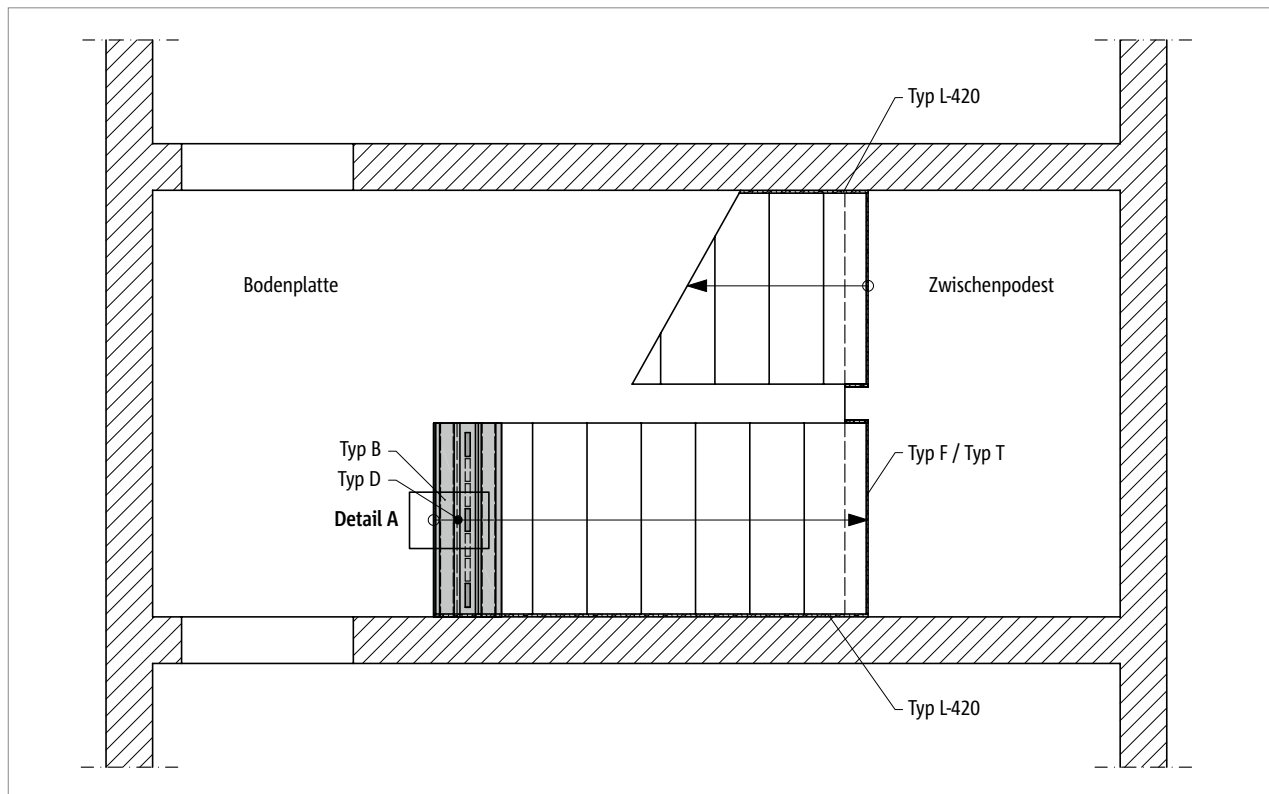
Schöck Tronsole® Typ B + Typ D: Elementanordnung im Grundriss
